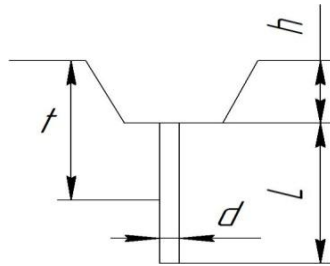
Схема розташування вертикального заземлювача в ґрунті:
